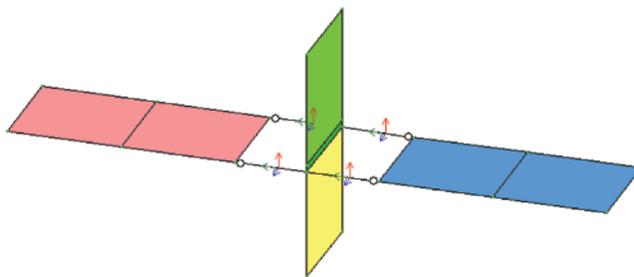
Конечно-элементная модель контактного стыка стен с опорием плит перекрытий на консоли
